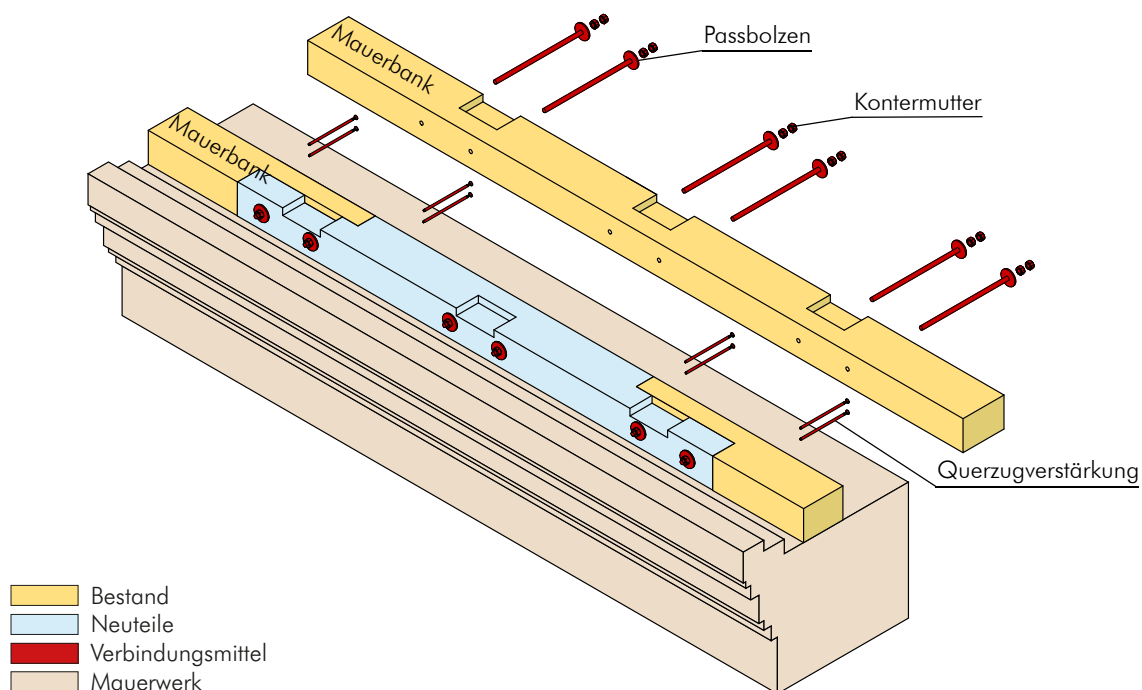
Explosionszeichnung der Instandsetzung der Mauerbank mittels geradem Blatt
